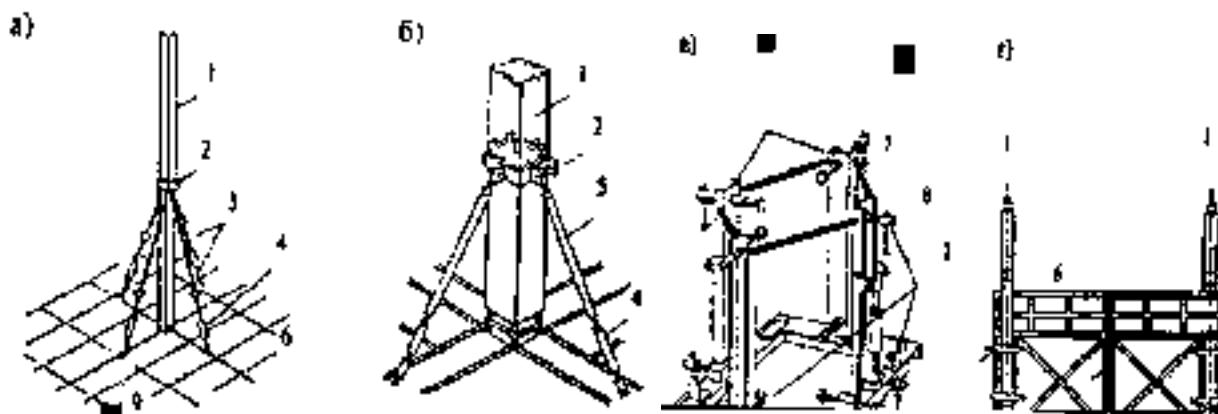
способы временного крепления железобетонных колонн многоэтажных зданий:
